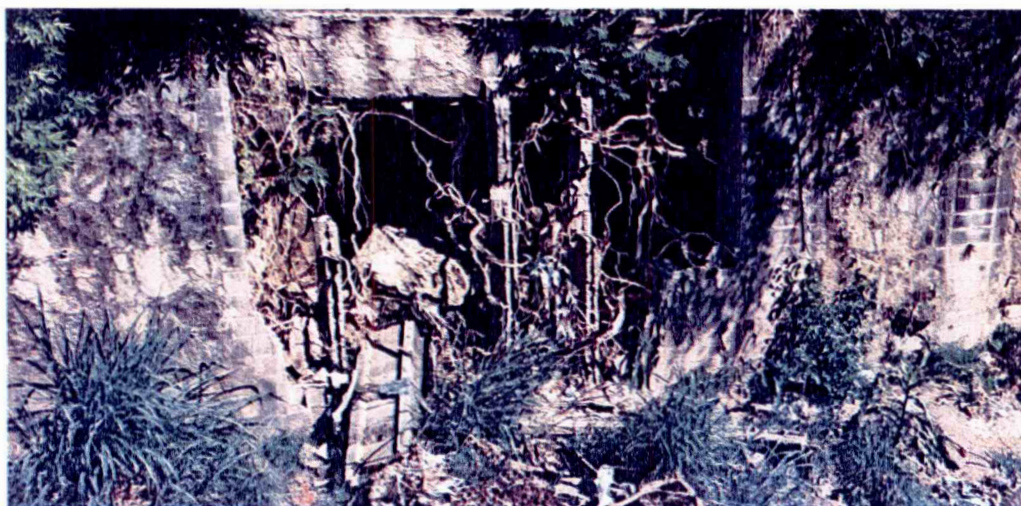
Vista hacia porción de muro desplomado en margen izquierda del Arenal Tutunichapa.
